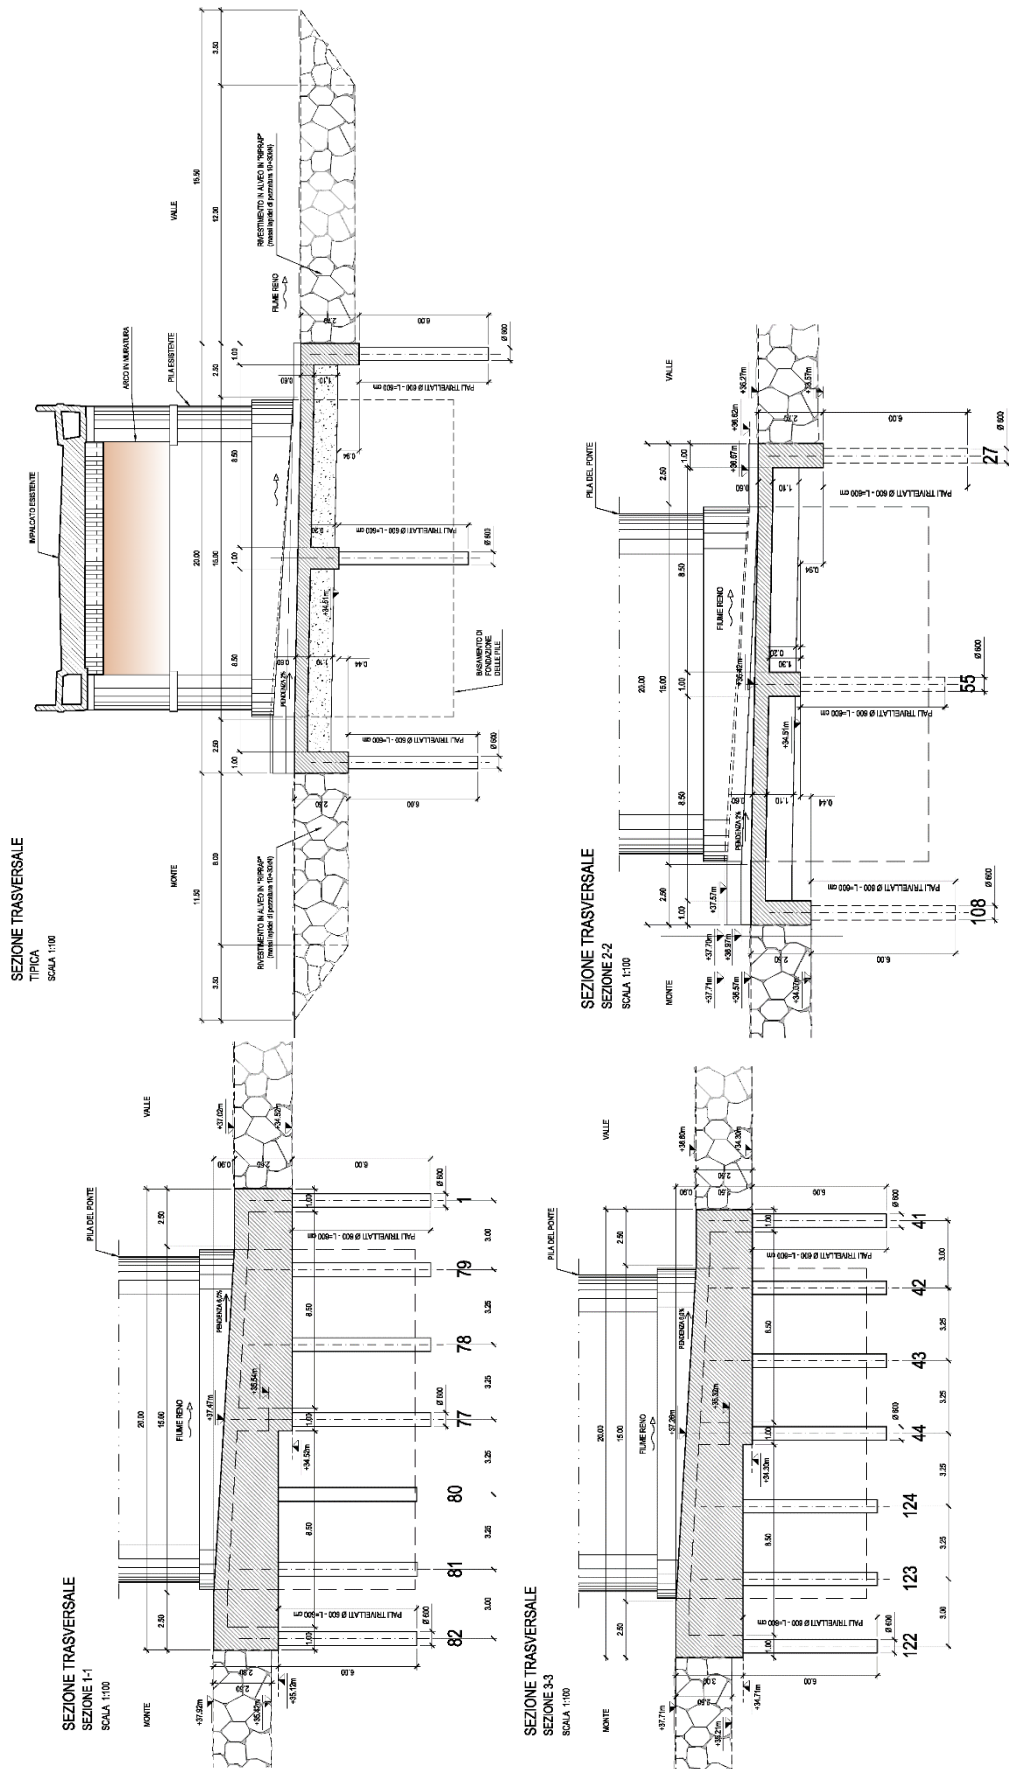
Sezione trasversale tipica e delle travi di estremità costituenti la briglia. [176]
